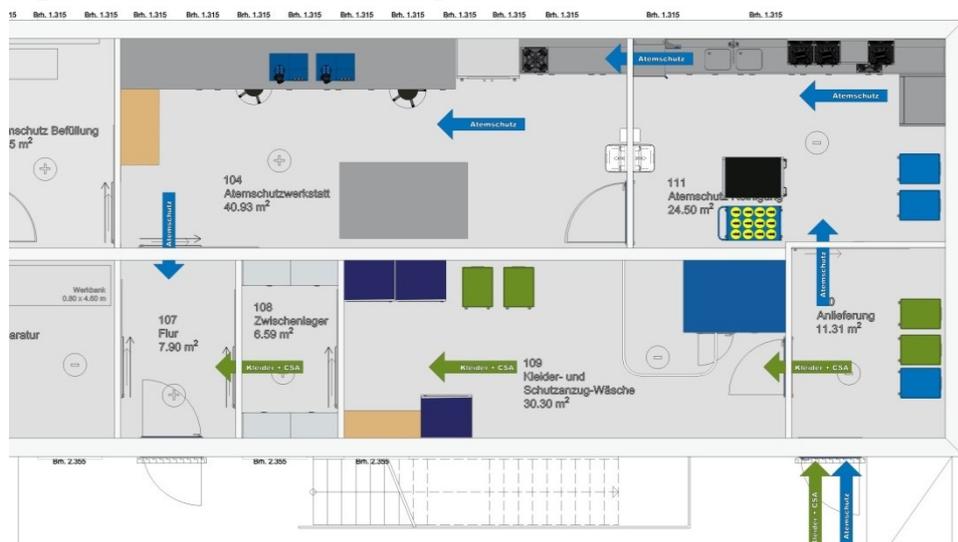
Grundriss der neuen Atemschutzwerkstatt
